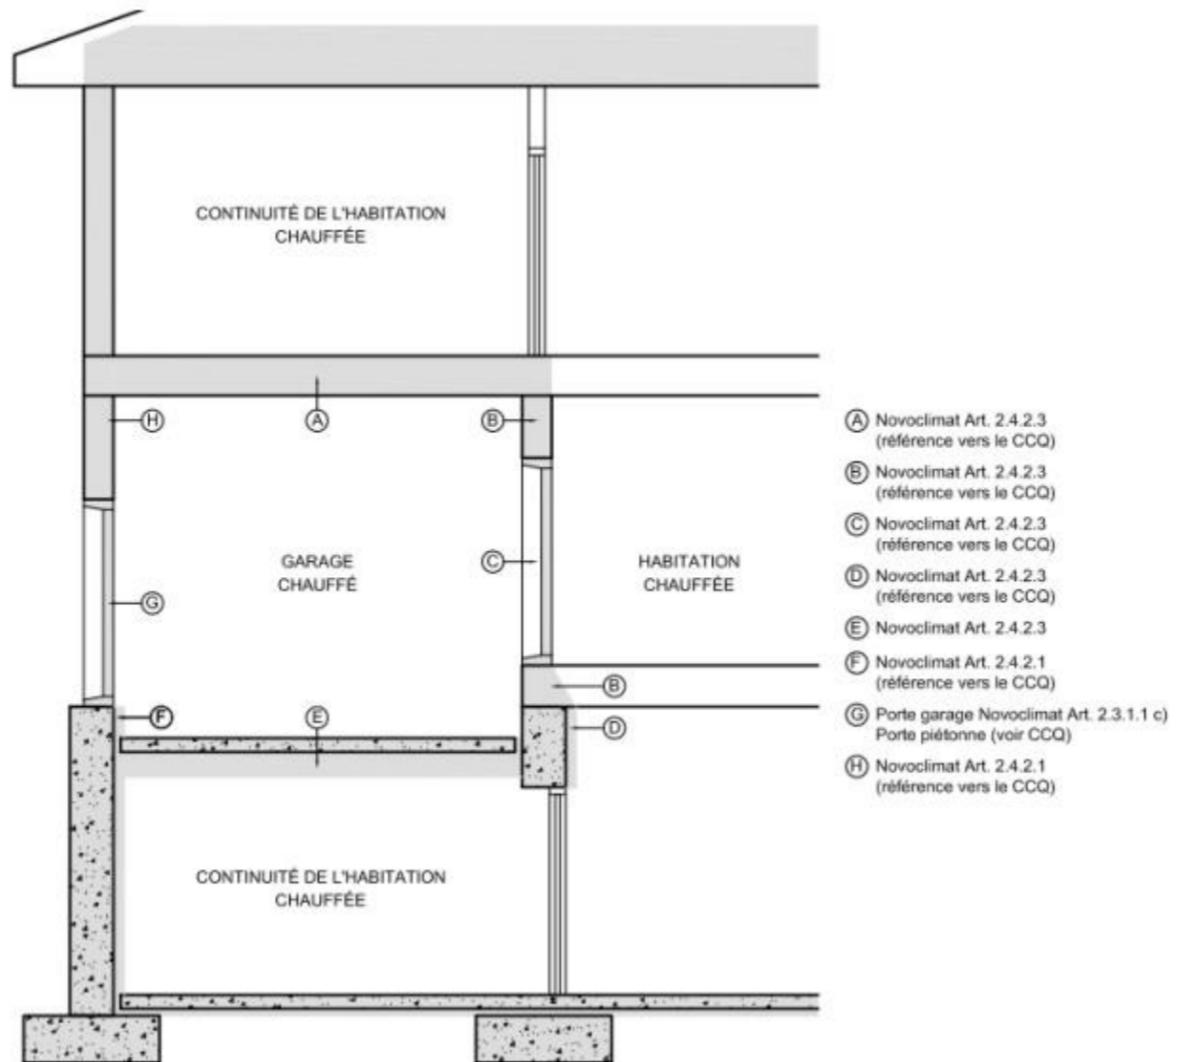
(suite) : Parois mitoyennes séparant un garage chauffé d'une pièce non chauffée.
